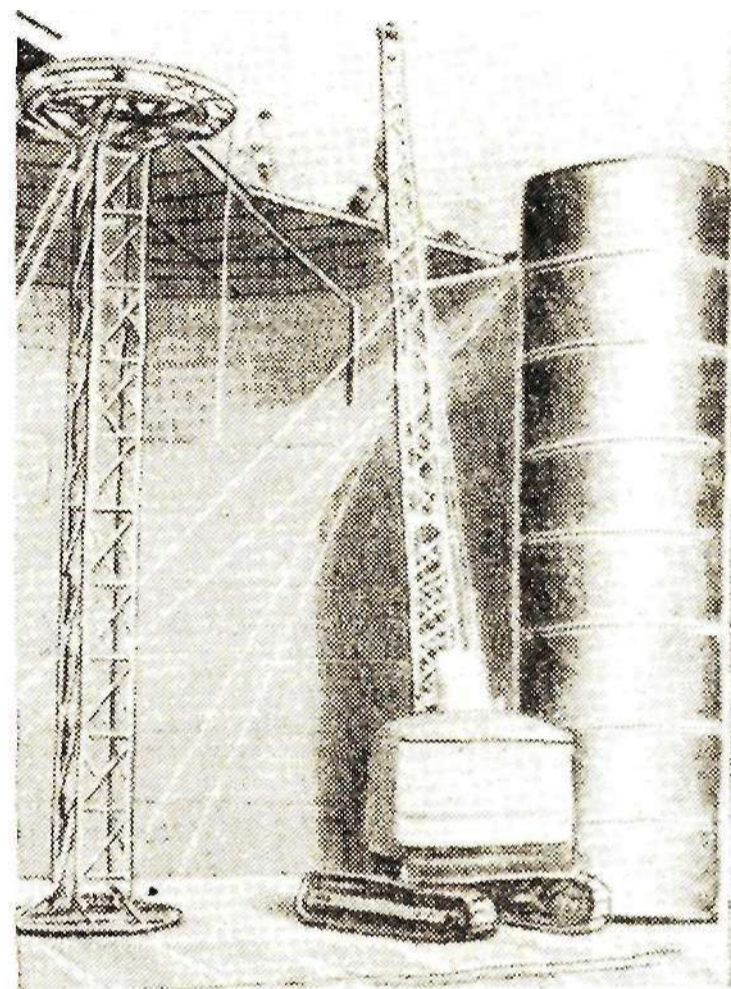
Монтаж рулонированного корпуса и кровли резервуара со щитовым покрытием
